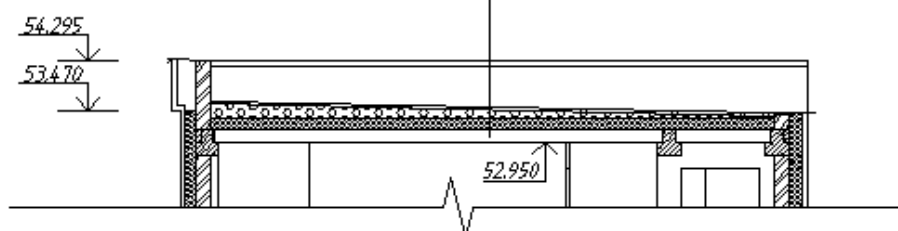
Конструкция покрытия над техническим этажом
